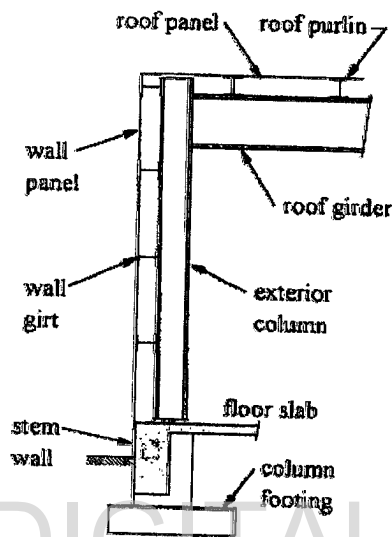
Estructuración de la fachada exterior de un edificio aporticado de acero tipo. Vista de perfil (Tomado del ASCE, 1997).
